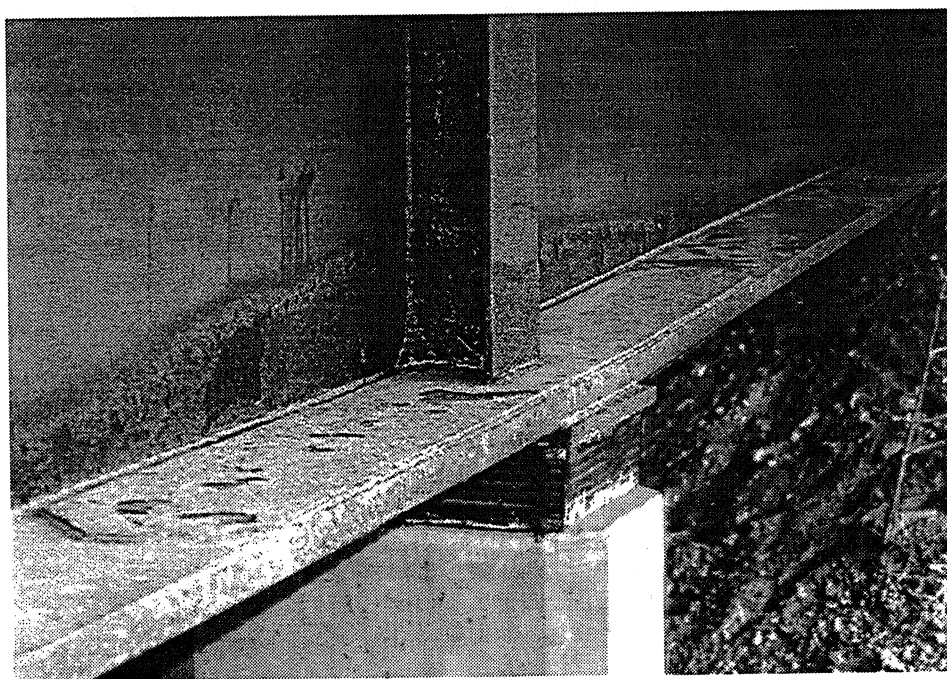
Eau stagnante ayant provoqué une oxydation locale marquée de la face supérieure de la semelle et de la partie inférieure de l'âme
